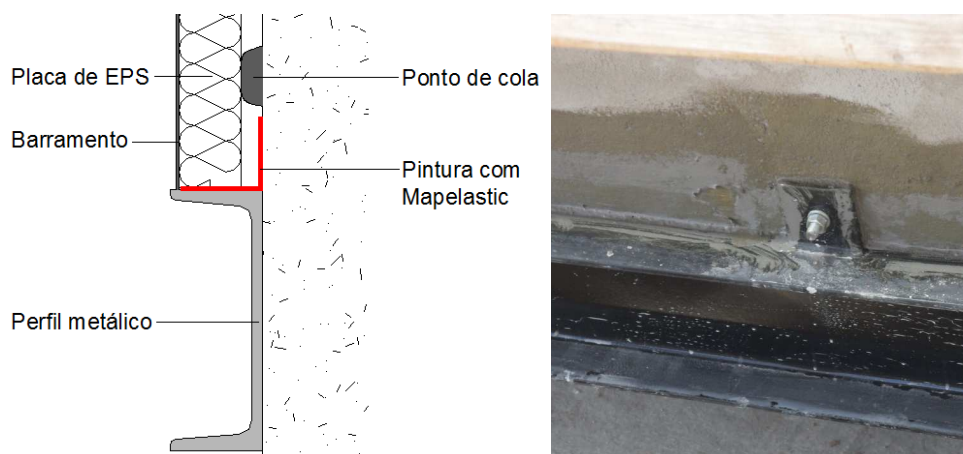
Pintura com “Mapelastic” na interface entre o perfil metálico colocado na fachada e o ETICS
